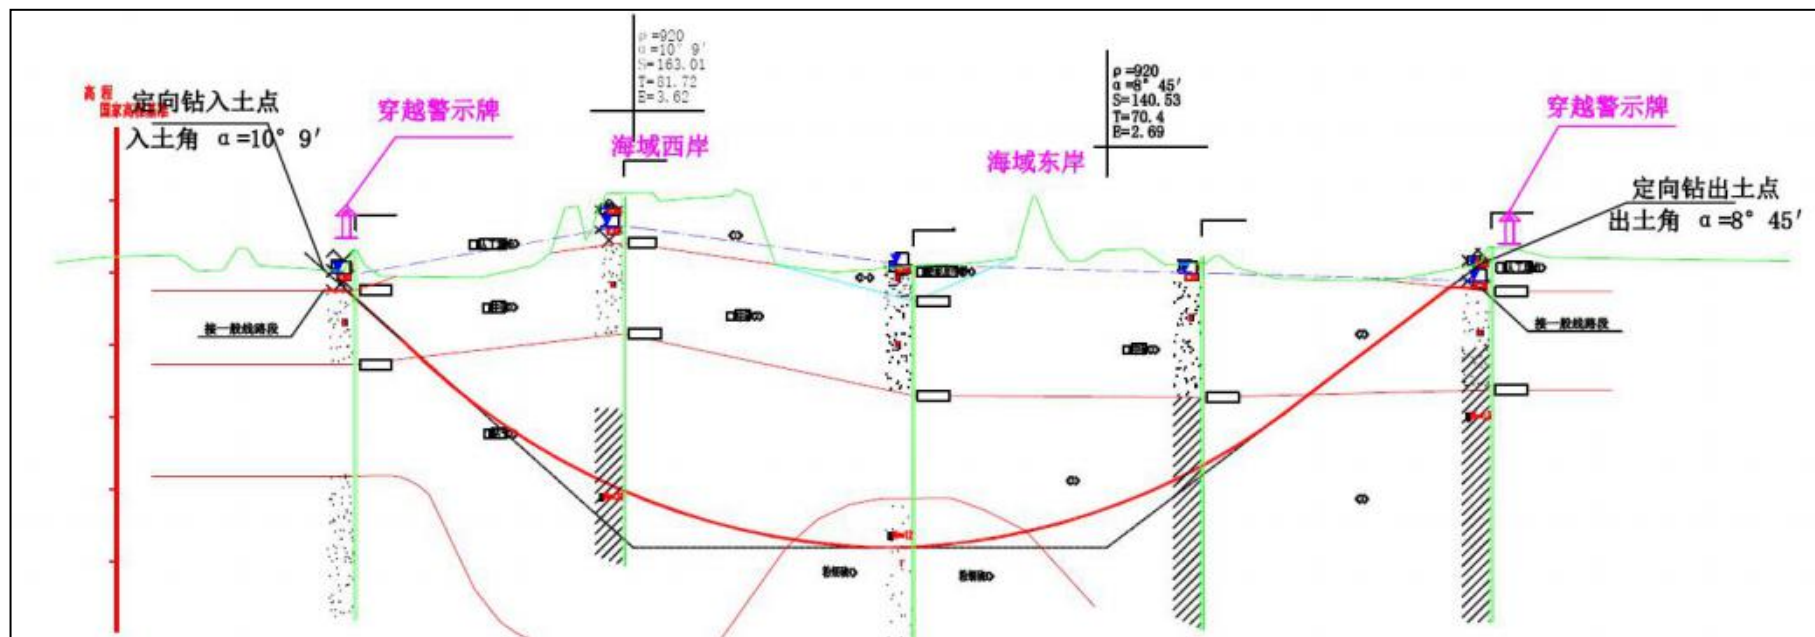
项目涉海段 2 管线定向钻穿越纵断面图
